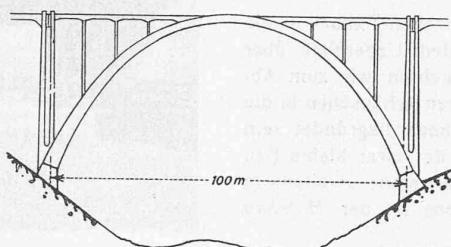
Eisenbahnbrücke Langwies, erbaut 1912/14.
